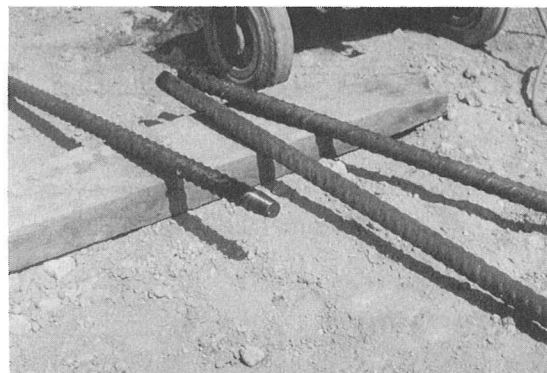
Puente del Centenario, en Sevilla. Extremo roscado.
